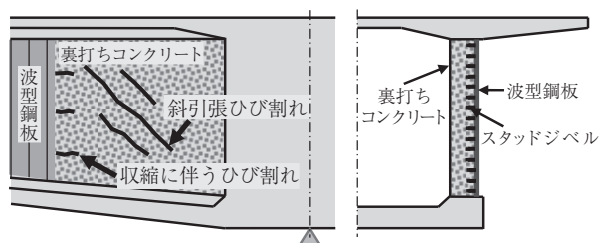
裏打ちコンクリートに想定されるひび割れ
